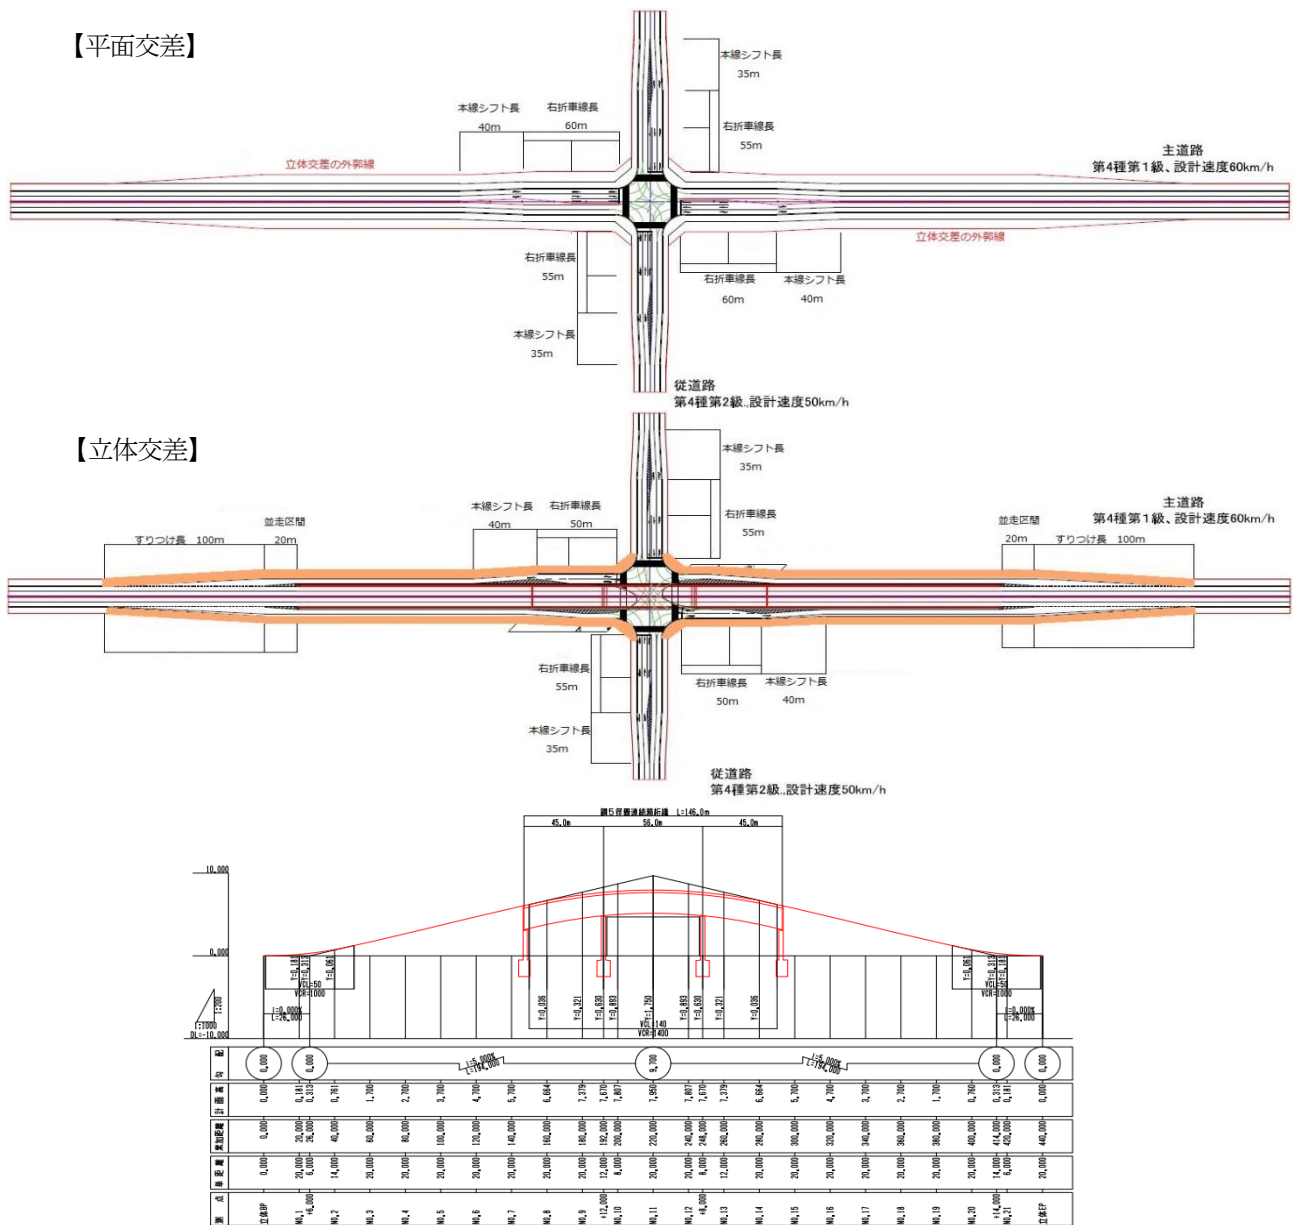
平面交差（平面図）および立体交差（平面図・縦断面図）
